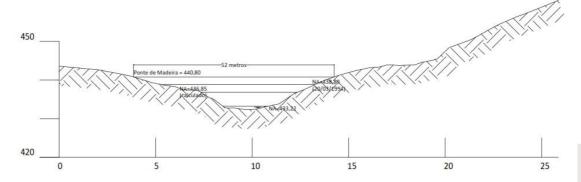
Seção no local de implantação da ponte sobre o Rio Sobretudo (Vão livre de 52,0 m)
